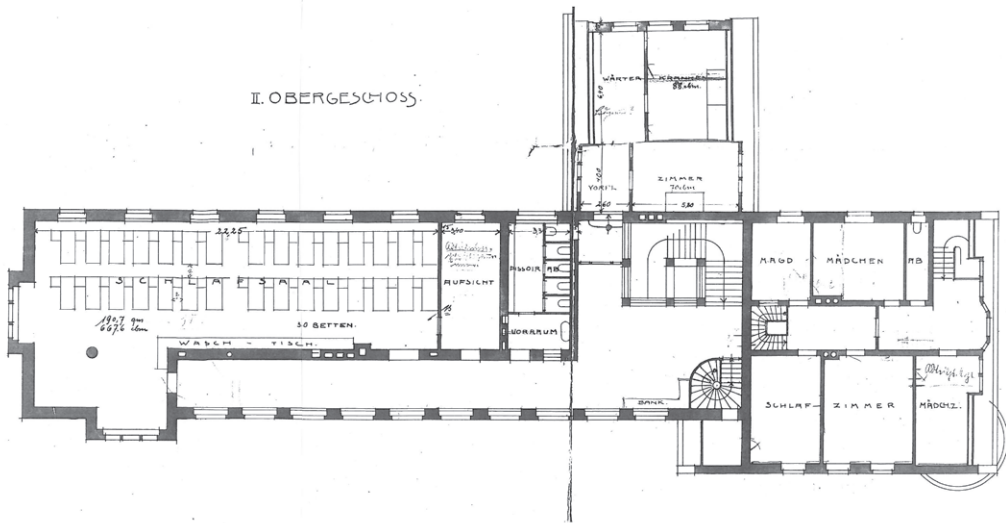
Grundrisse, Plansatz von Carl Jäger, 1904
